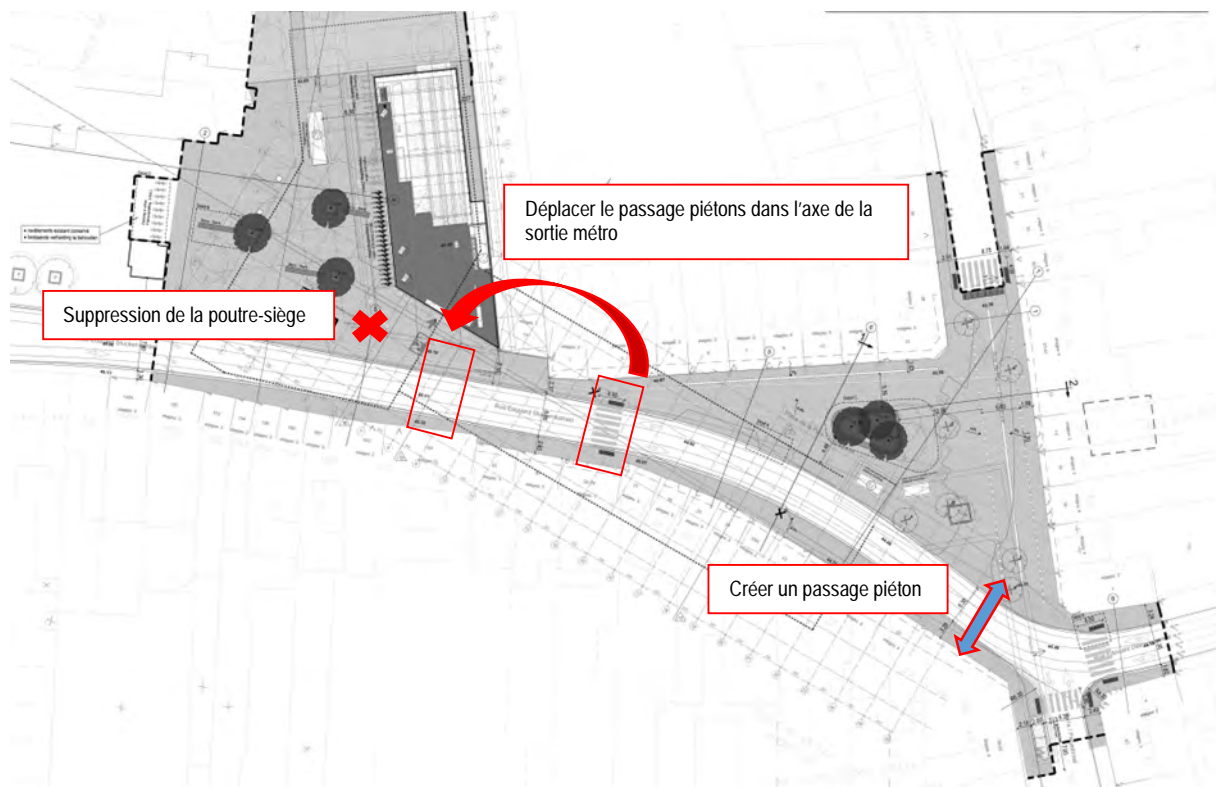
Illustration des recommandations pour la circulation des piétons et PMR : Repositionner le passage piéton et suppression de la « poutre-siège » (ARIES, 2020 sur fond de plan BMN, 2018)
